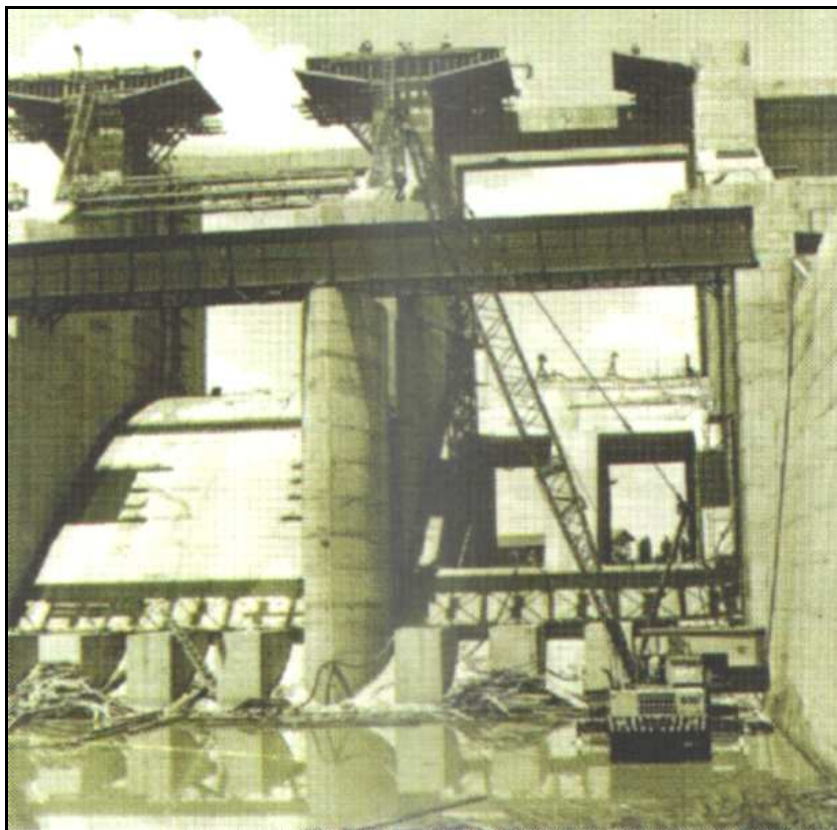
Vista da construção dos vertedouros (FONTE: FURNAS).
